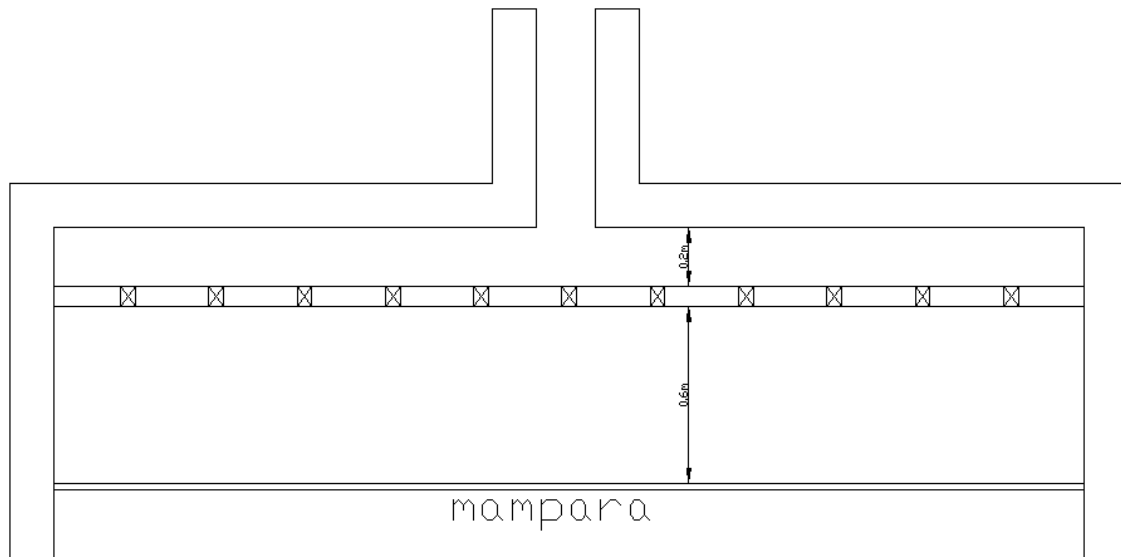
Vista en Planta del mecanismo de entrada al tanque sedimentador primario.
